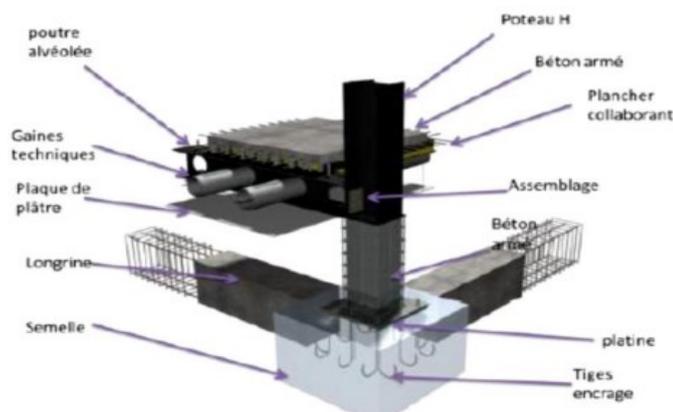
Détail d'assemblage poteau-poutre-plancher
